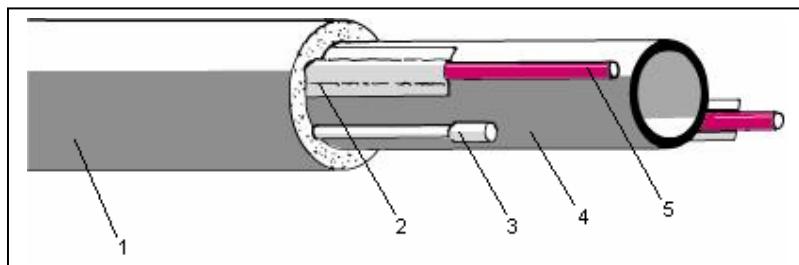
Монтаж нагревательного кабеля на водопроводных трубах.
